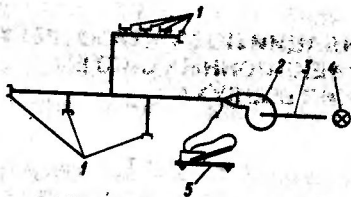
Схема присоединения переносной вентиляторной установки при испытаниях воздуховодов на герметичность
